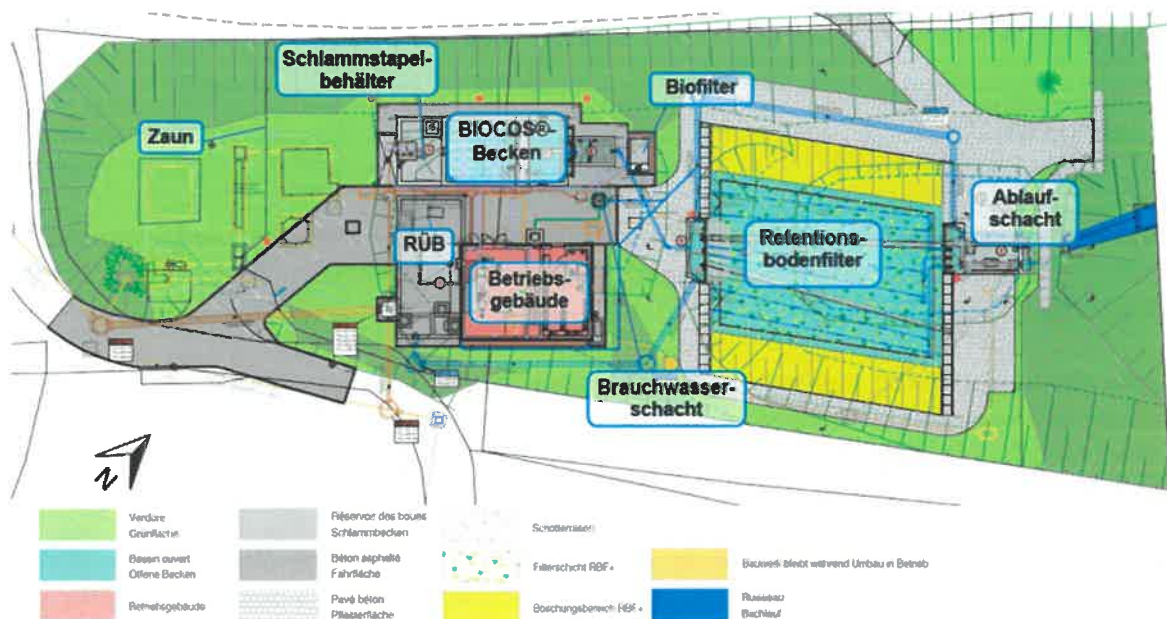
Ausschnitt Lageplan - Anordnung der Bauwerke der Kläranlage
